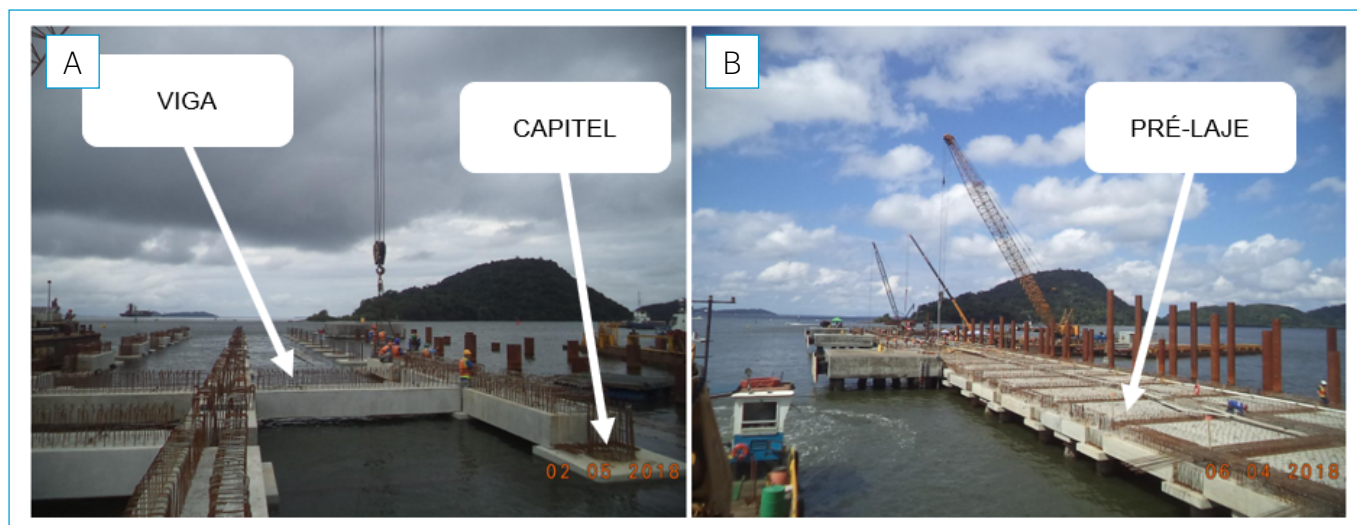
Concepção estrutural do cais portuário, abrangendo ligação entre estacas e supraestrutura composta de capiteis, pré-lajes, vigas e lajes.
